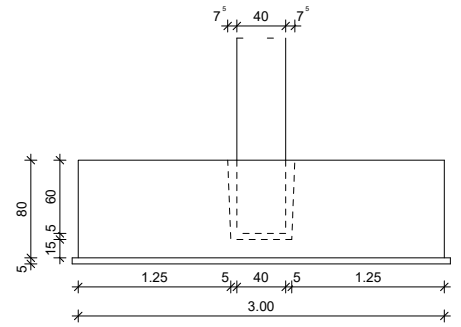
Schnitt durch Fundament mit Anschlussbewehrung
